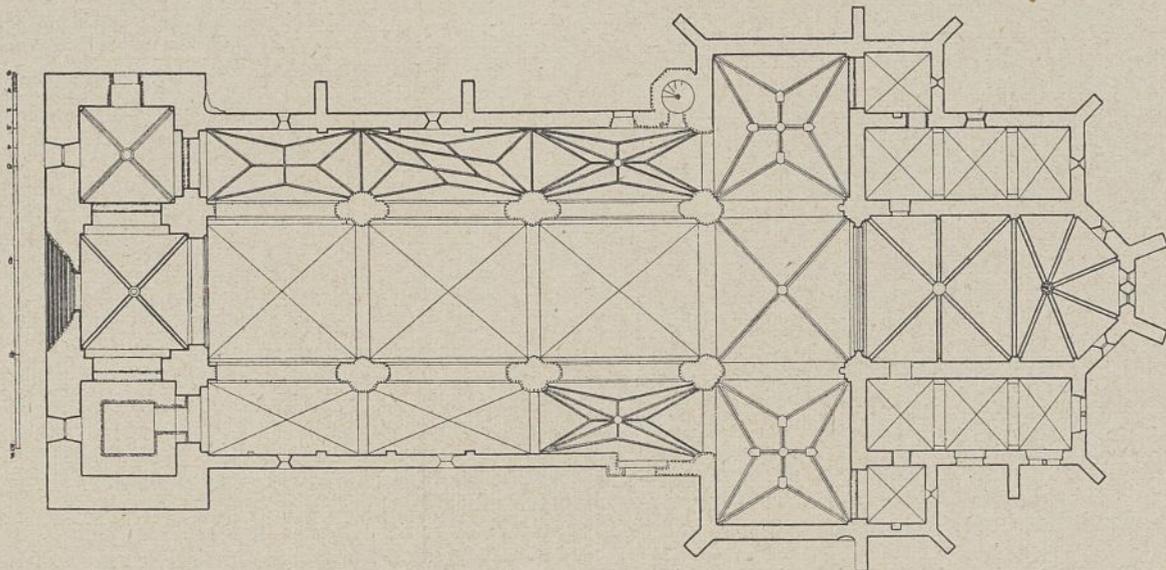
Grundriß vom jetzigen Zustande. M 1:400.
